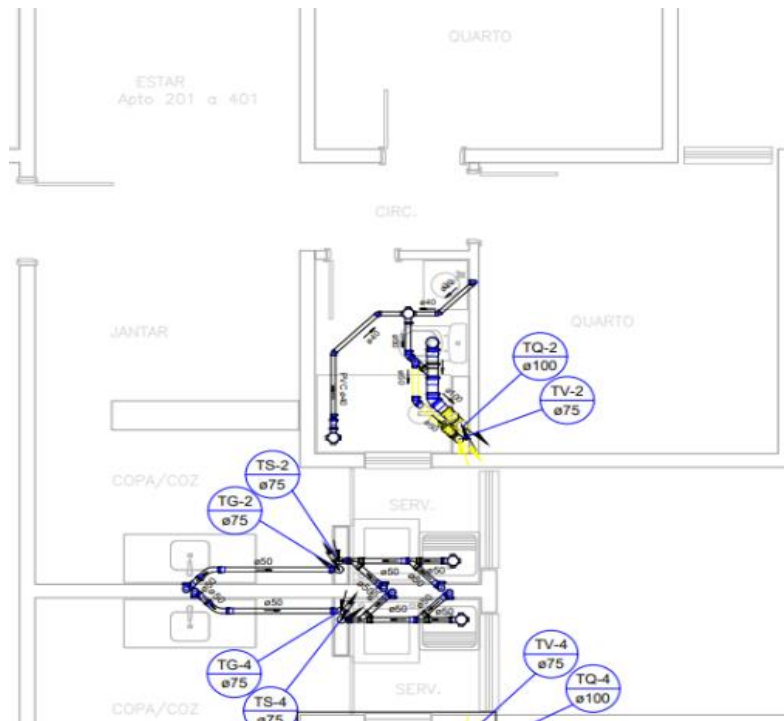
Empreendimento 1 – Detalhamento Projeto Hidrossanitário
